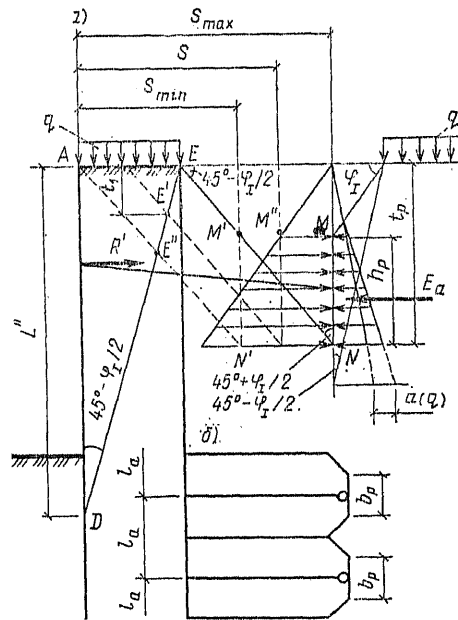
К расчету анкерной плиты при горизонтальной поверхности грунта
